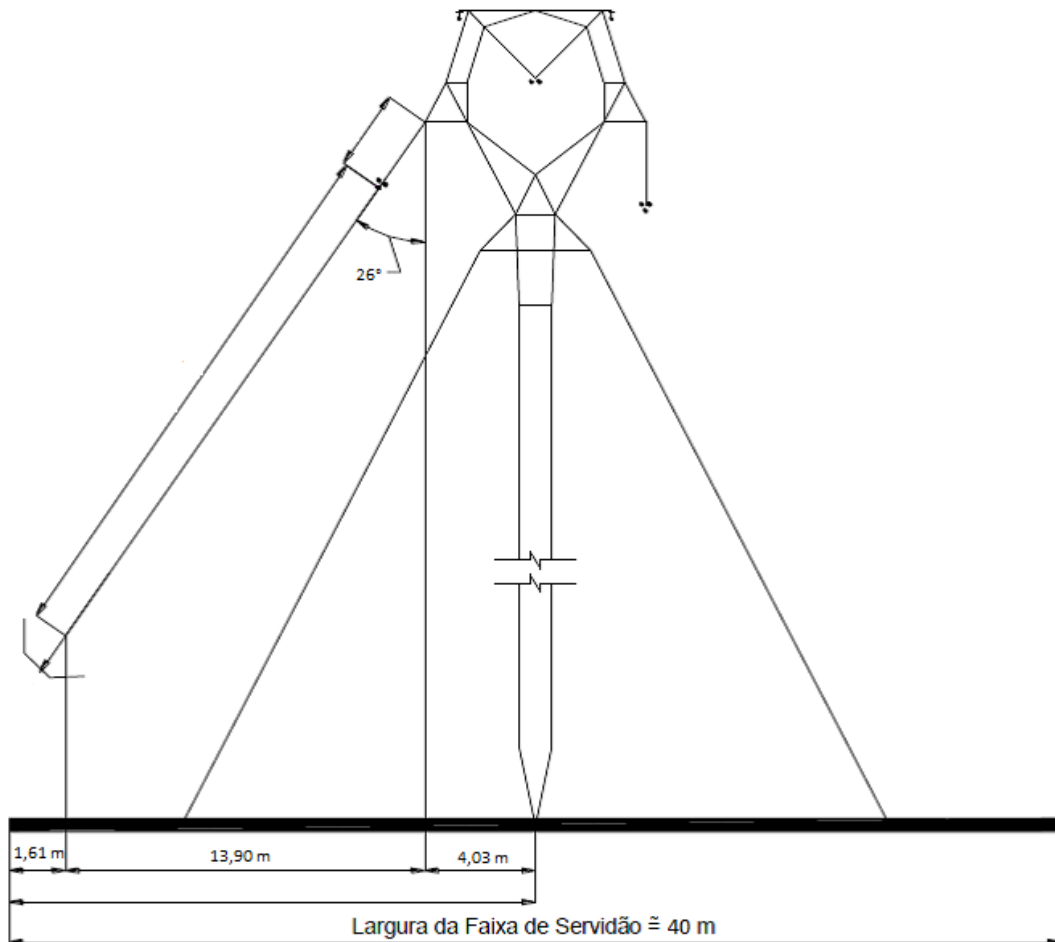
Esquema da faixa de servidão de 40 m.
